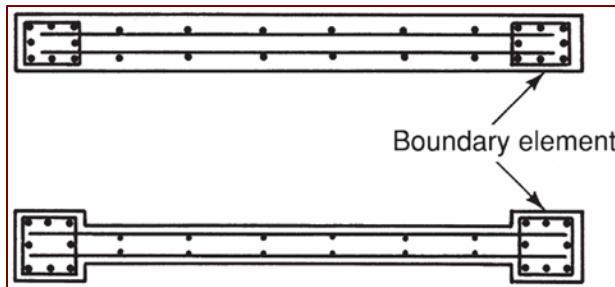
Vista en planta de los muros estructurales con elementos de borde.
